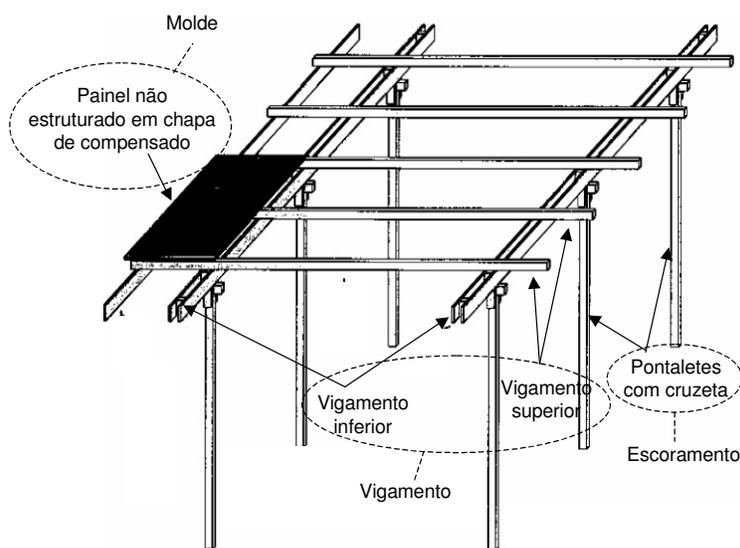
Esquema de fôrma para laje com escoramento pontual em madeira.
